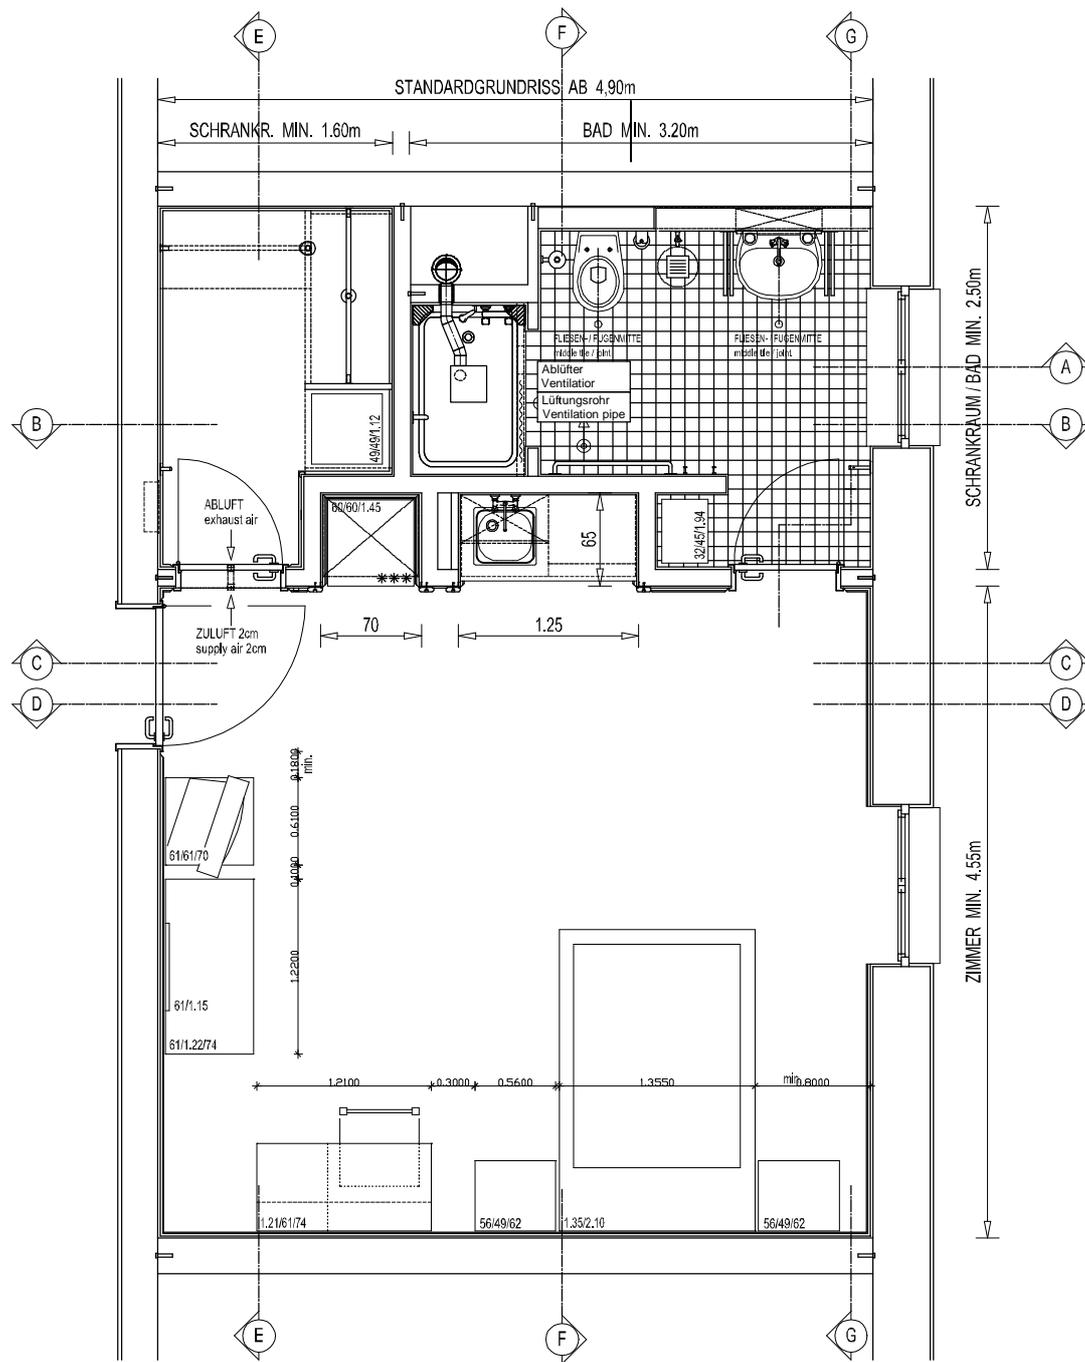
4 Beispielgrundriss Typ 4
